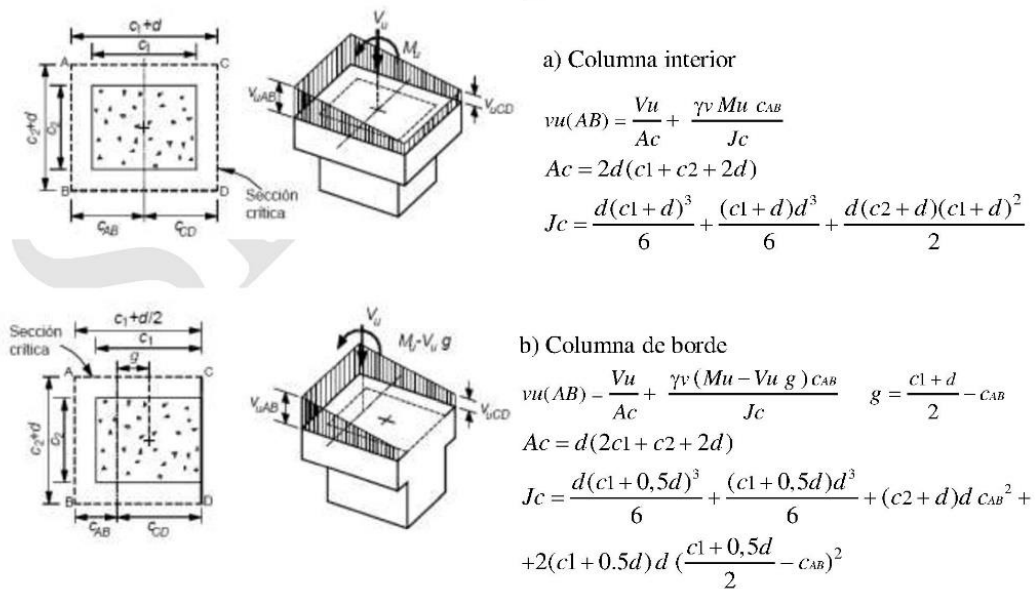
Distribución de los esfuerzos cortantes en el perímetro de la sección crítica en conexiones losa a columna.
